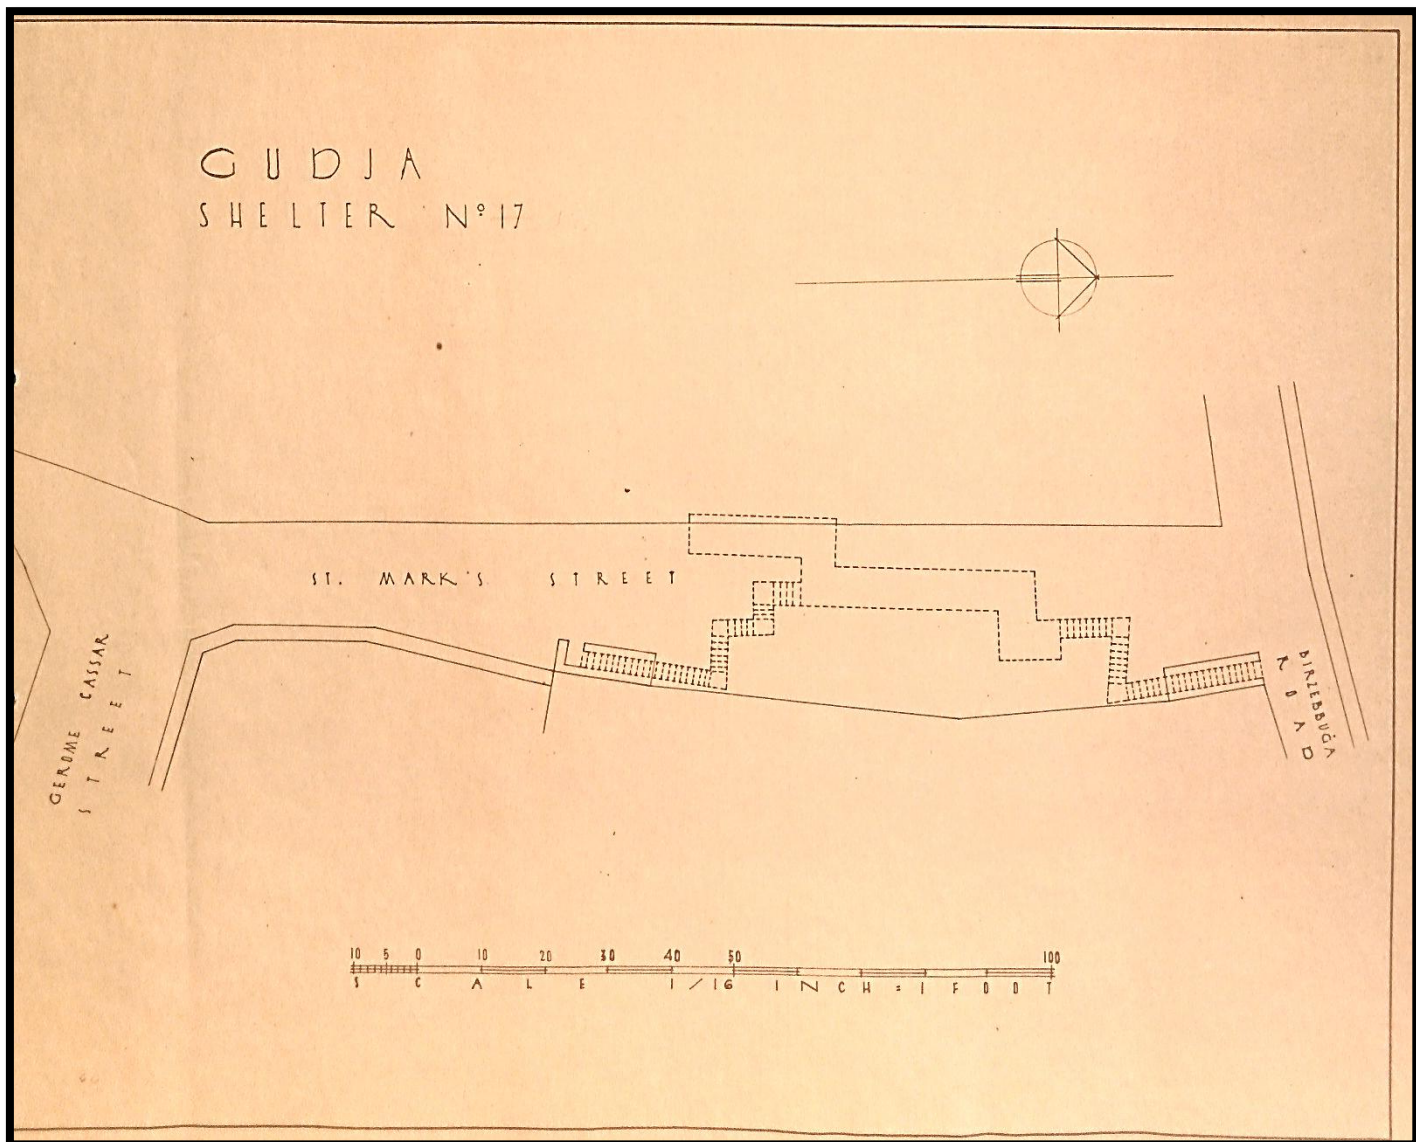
Planta do Abrigo nº17 "Gerome Cassar Street – St. Mark's Street – Birzebbuga Street."
